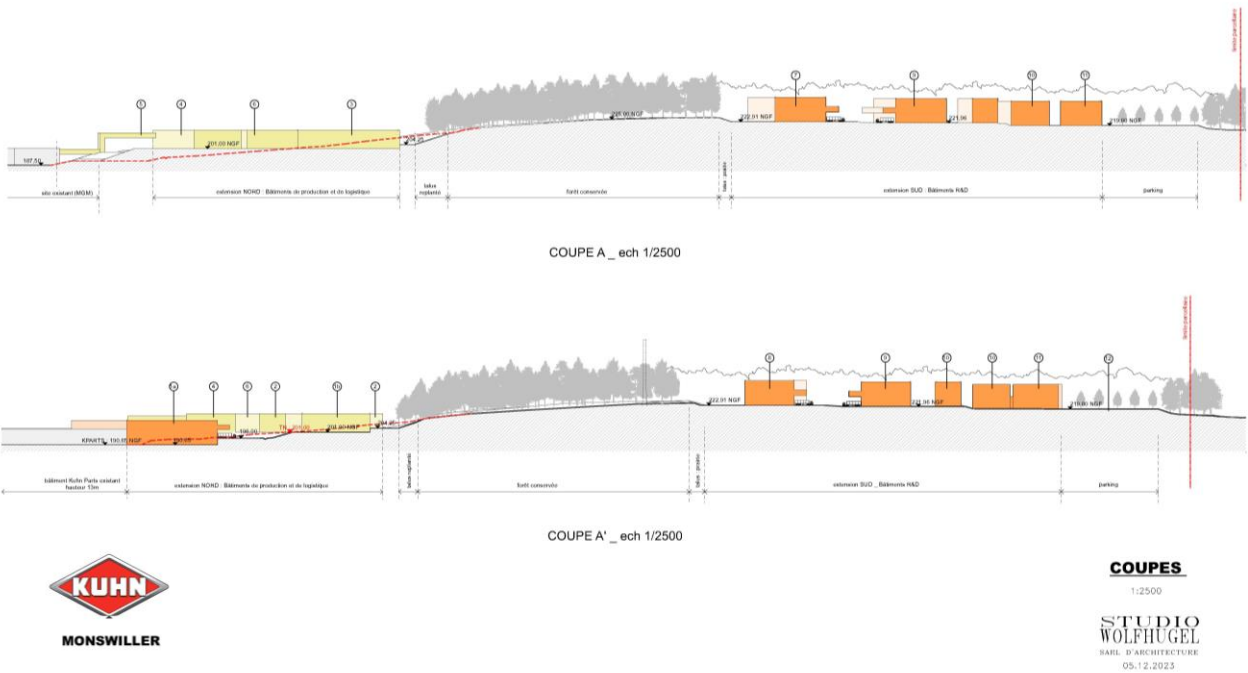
COUPE ILLUSTRANT L'IMPLANTATION DU PROJET D'AGRANDISSEMENT DU SITE DE KUHN
